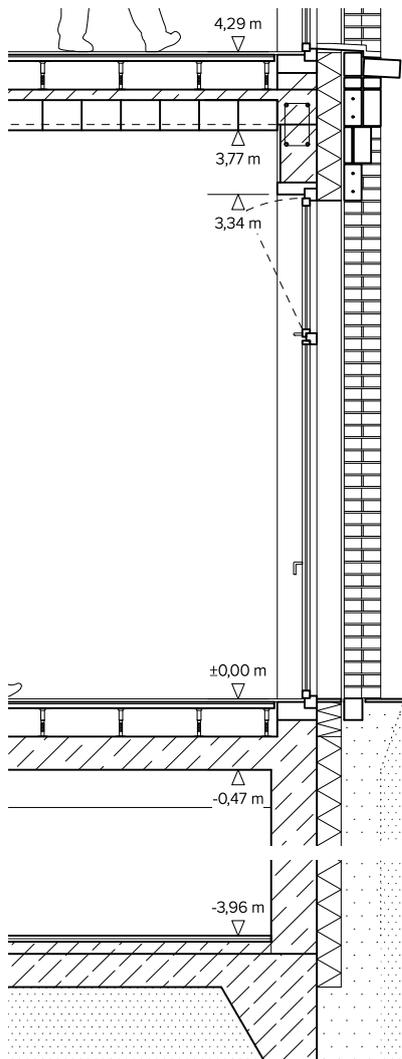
Fassadenschnitt Untergeschoss und Erdgeschoss 1.50 (BM)
